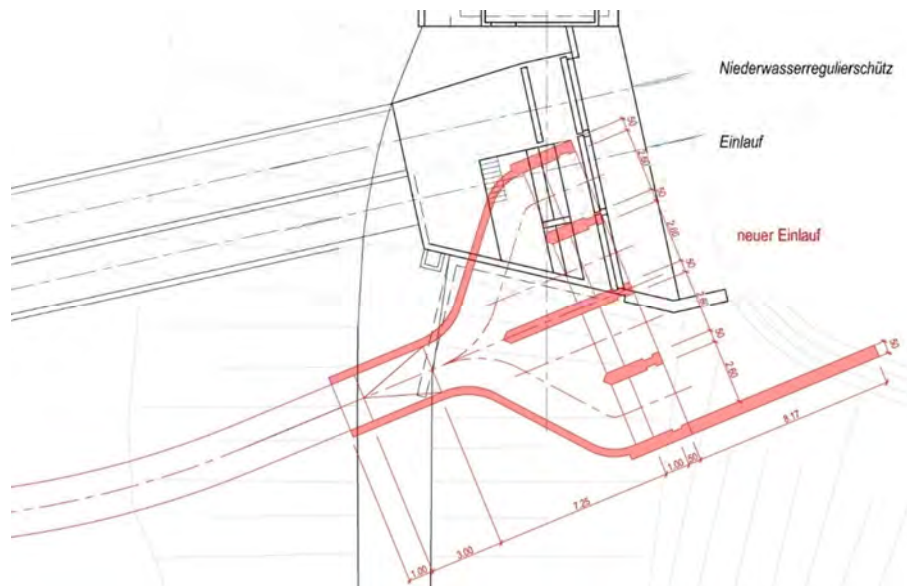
Grundriss der neuen Seewasserfassung.
